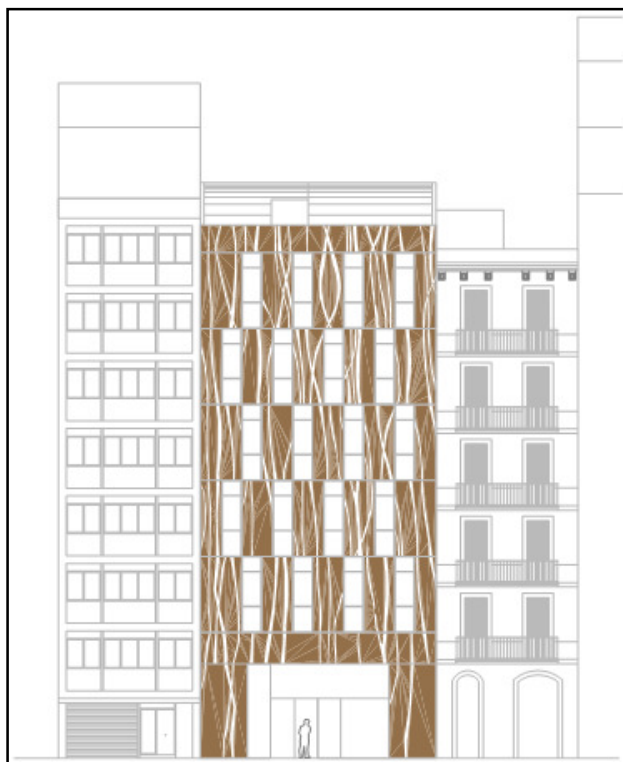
Alzado de la fachada principal (Pich-Aguilera Architects).
